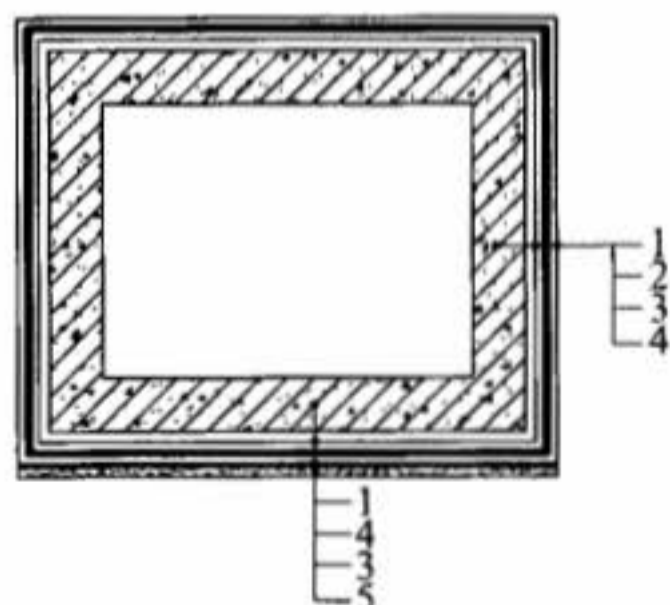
明挖法地下结构丙烯酸盐喷膜防水层构造示意
